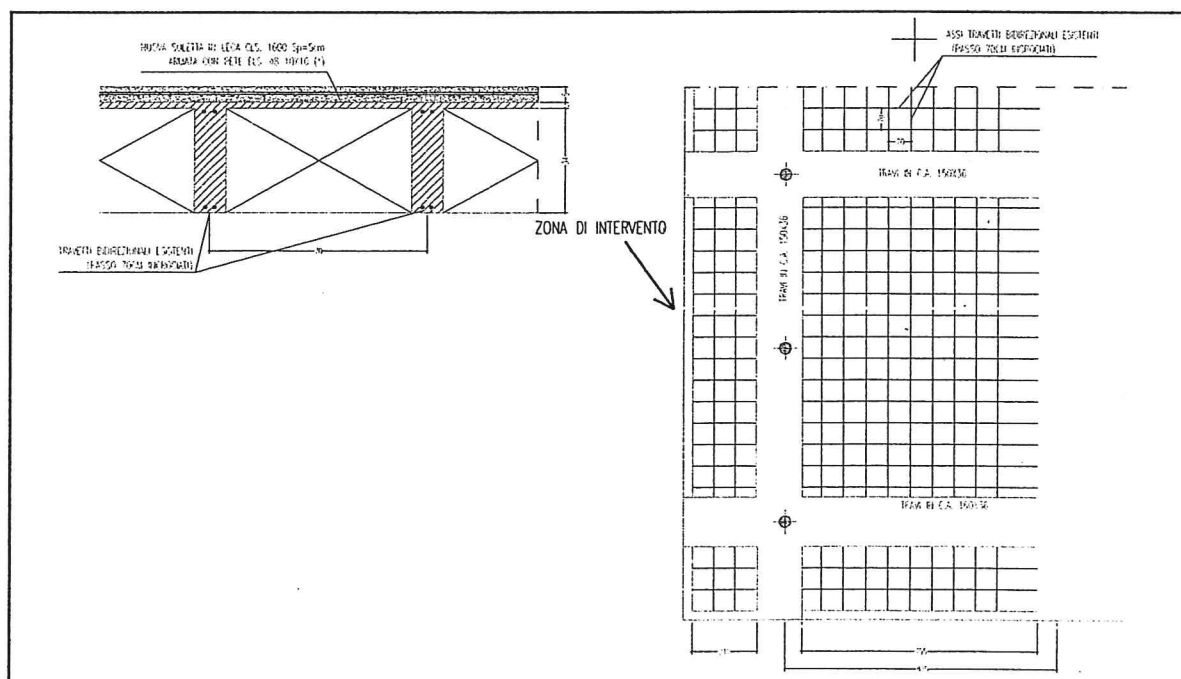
Schema ubicazione prova – Pianta IV° Piano
